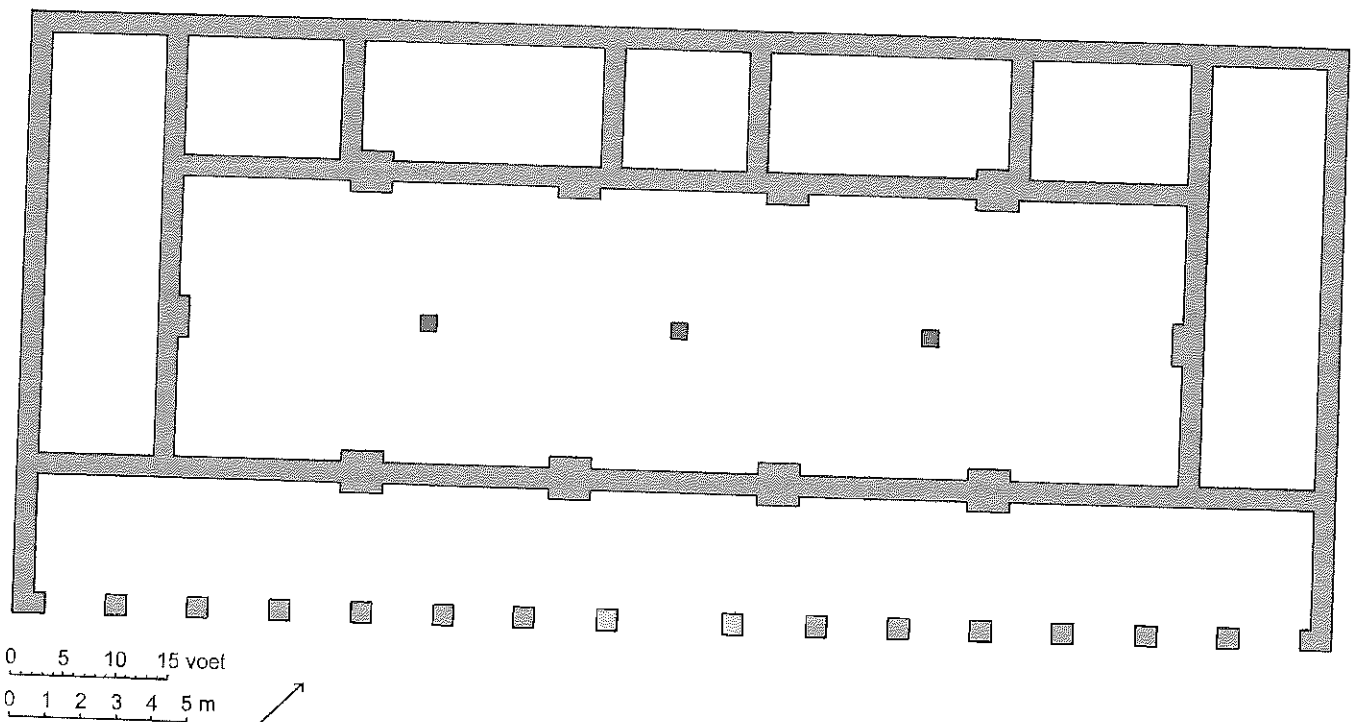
Gereconstrueerd grondplan van het hoofgebouw.
